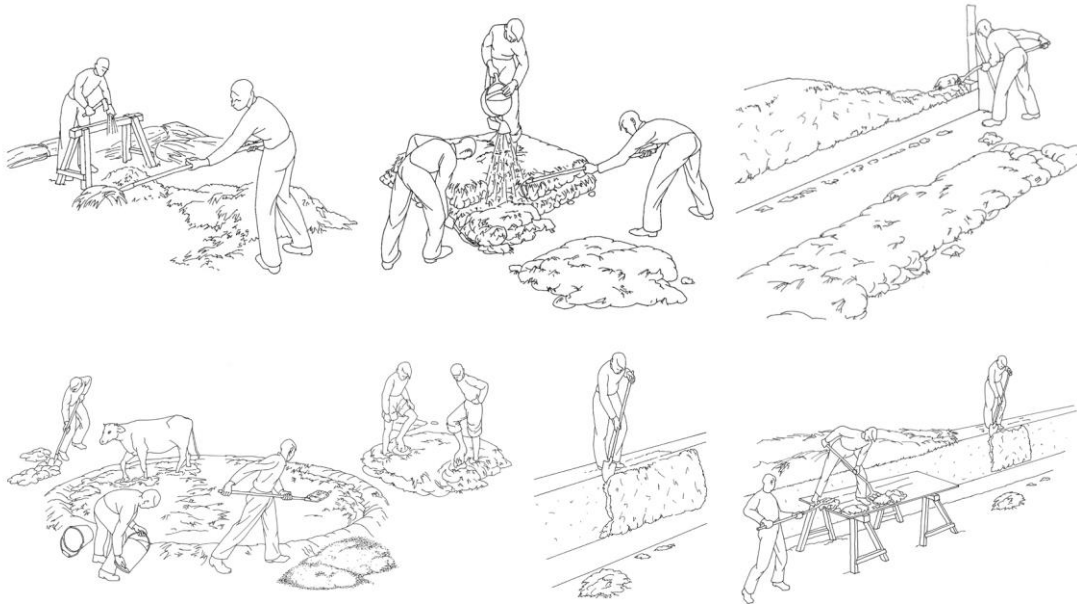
Arbeitsschritte der Wellerlehmbauweise (Quelle: Roswag-Ziegert, 2014, <https://www.holcimfoundation.org/projects/locally-manufactured-cob-and-bamboo-school-building-jar-maulwi>)
